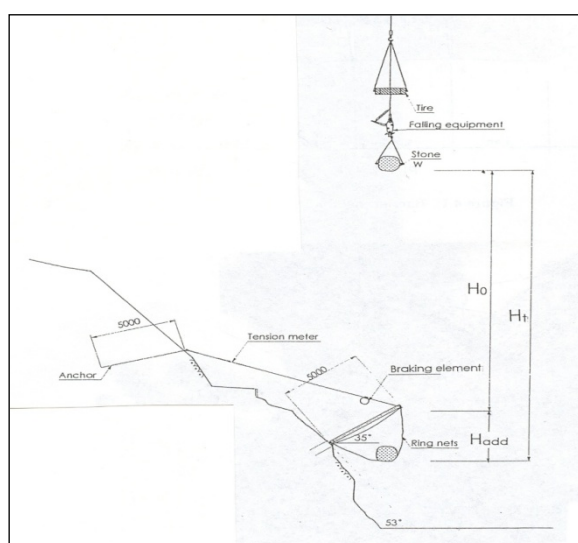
Site d'essai utilisé par l'institut japonaise, [MUR 99]
